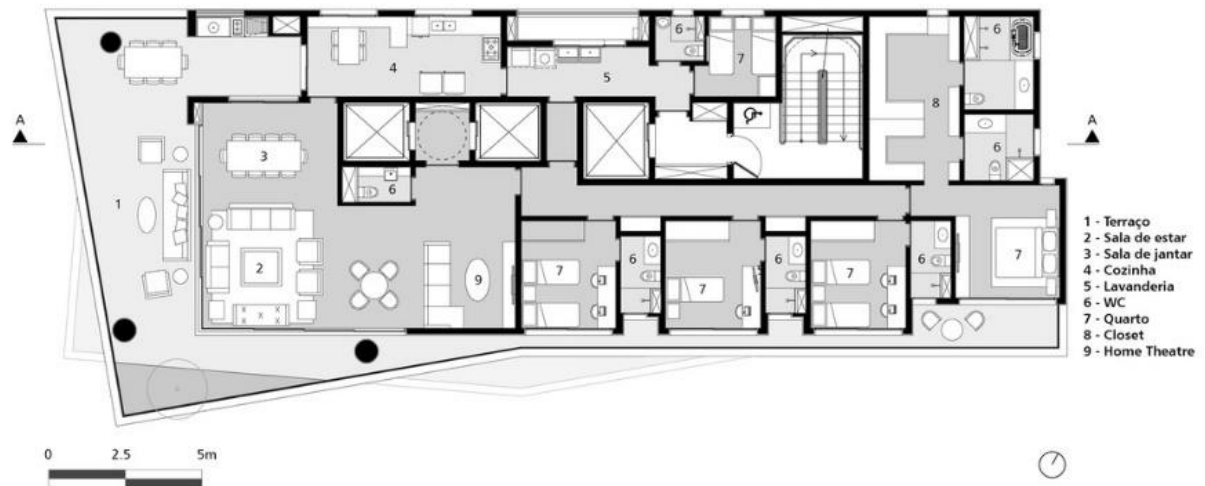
Planta Baixa Tipo - Pavimentos Ímpares
